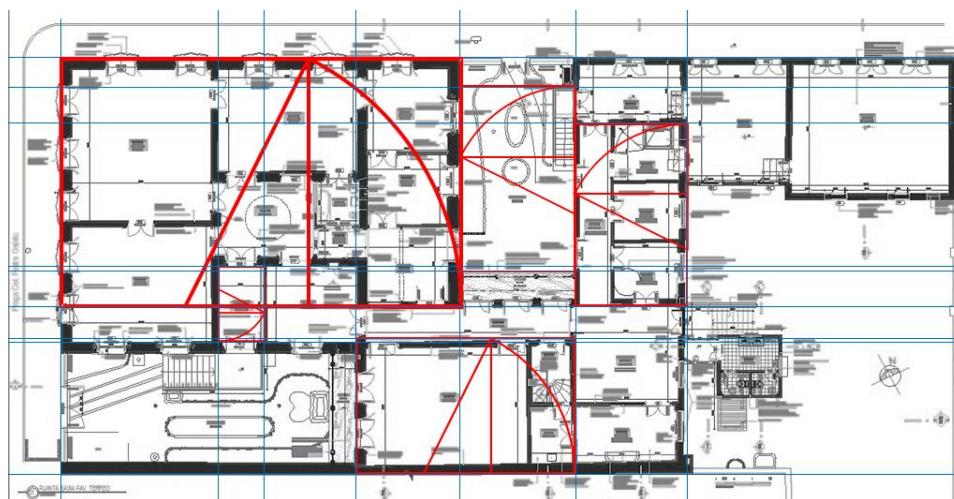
Análise geométrica de proporções da planta do pavimento térreo.
